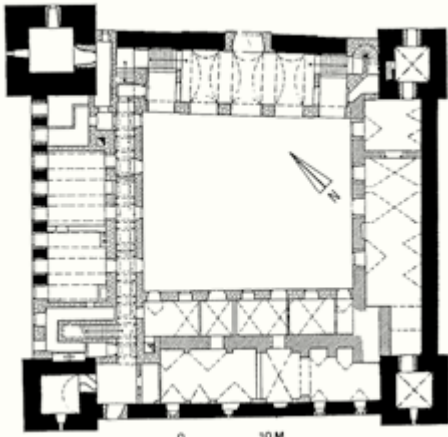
Grundriss der Kastellburg Ebenfurth mit Hervorhebung der Bauteile des 13. Jahrhunderts
